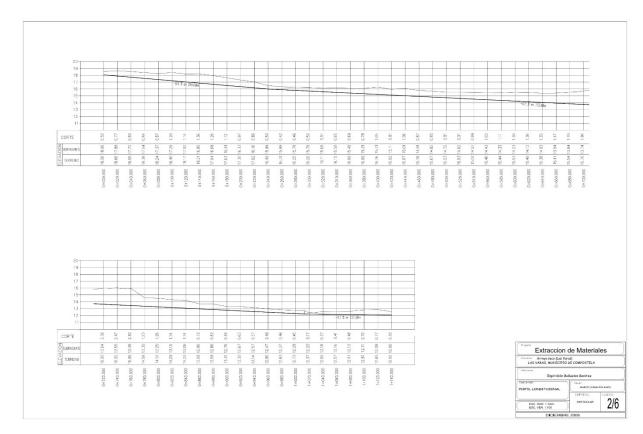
Perfil longitudinal y seccionamiento del eje 1
